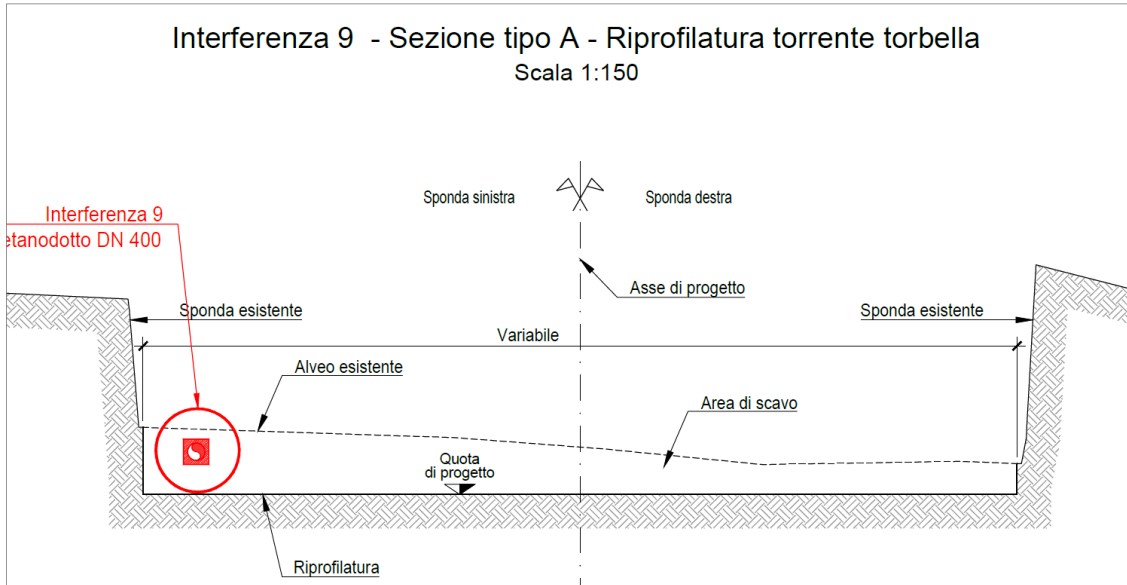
Sezione trasversale (tipo "A") della nuova riprofilatura del t. Torbella e rappresentazione del manodotto interferente con l'area di scavo in sinistra idraulica
